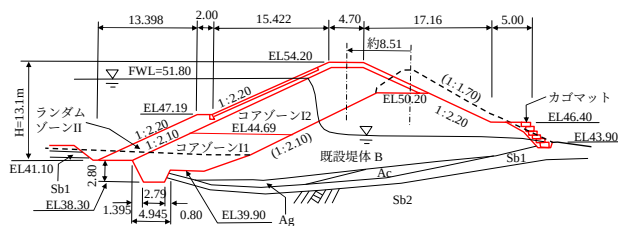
長原口池の改修後堤体の標準断面 (No.4 断面)
